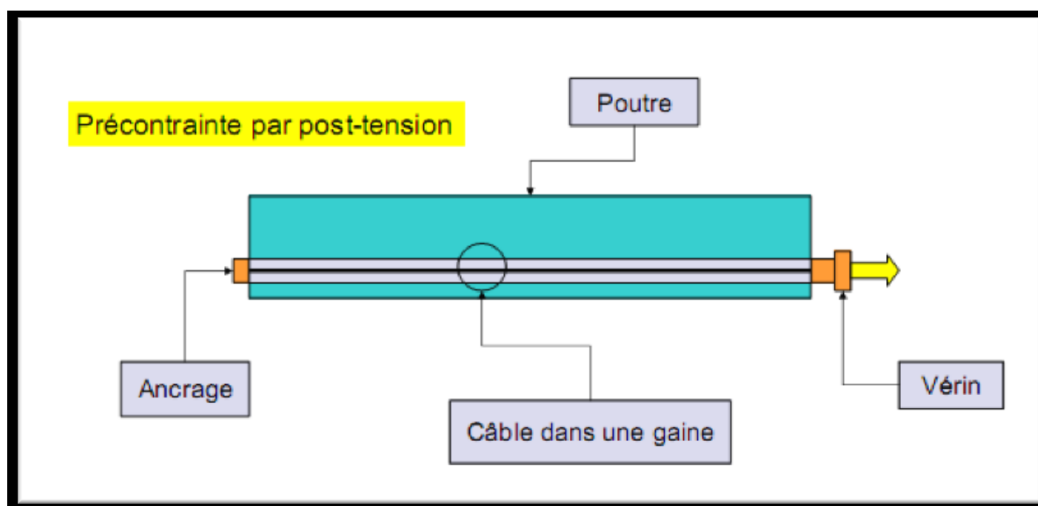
Coupe longitudinale d'une poutre en béton précontraint par post tension.
